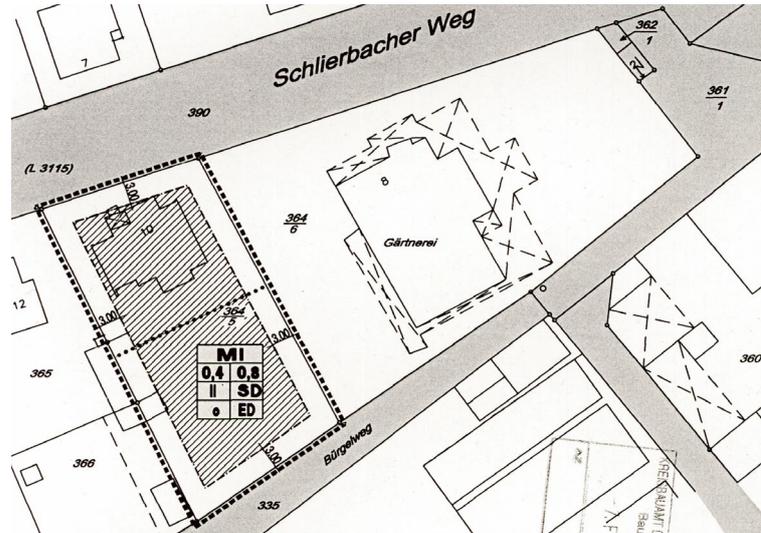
Ausschnitt des Bebauungsplans "Schlierbacher Weg 10"
